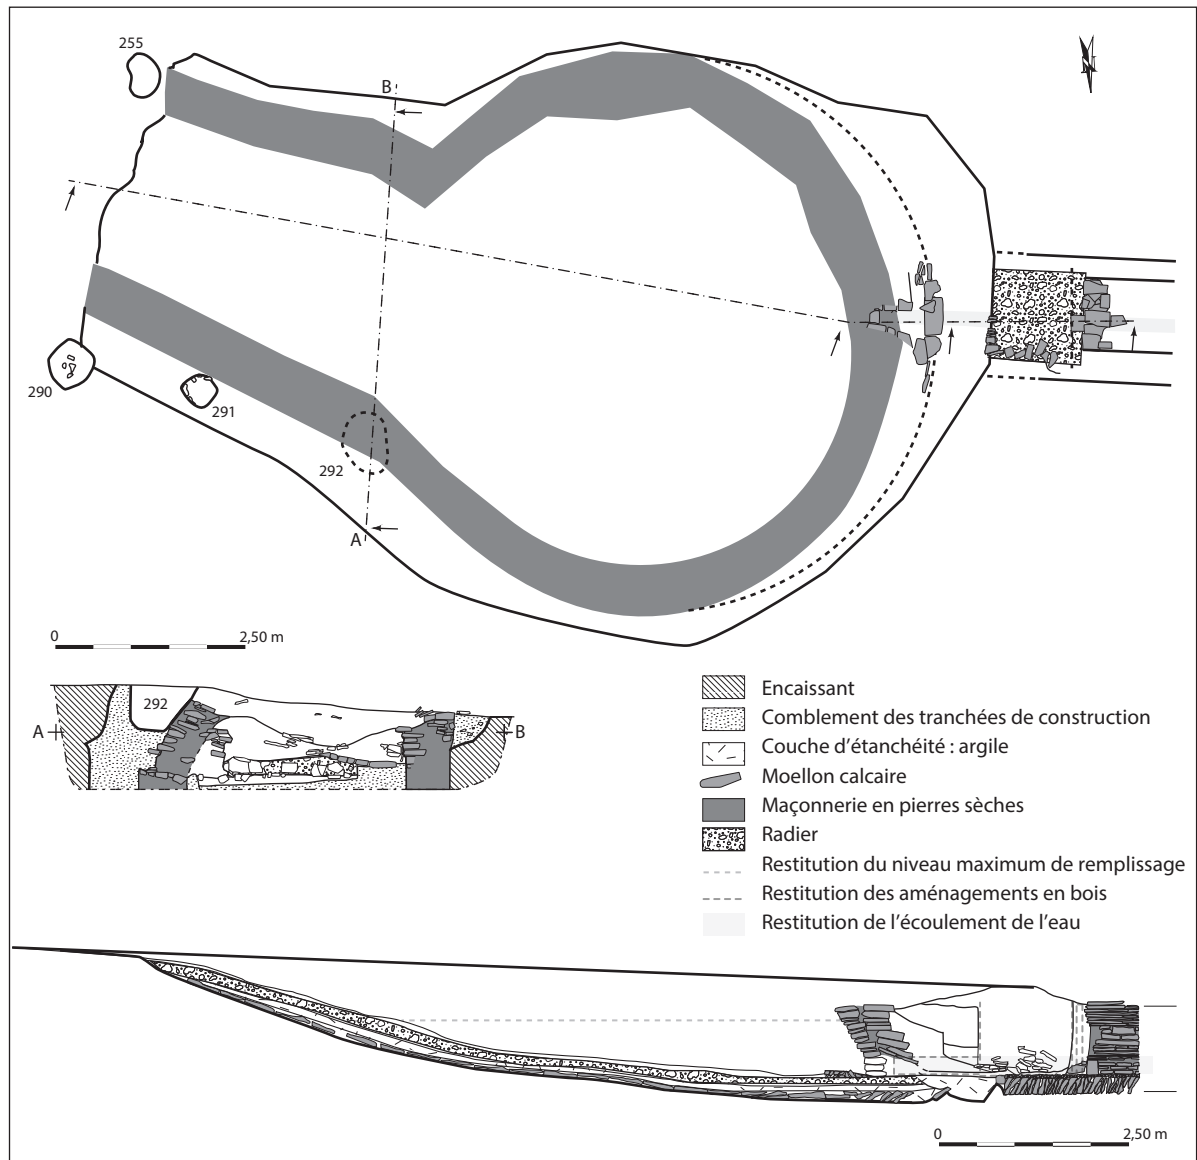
Relevés en plan et en coupe du pédiluve (DAO : M. Mondy, Inrap).
